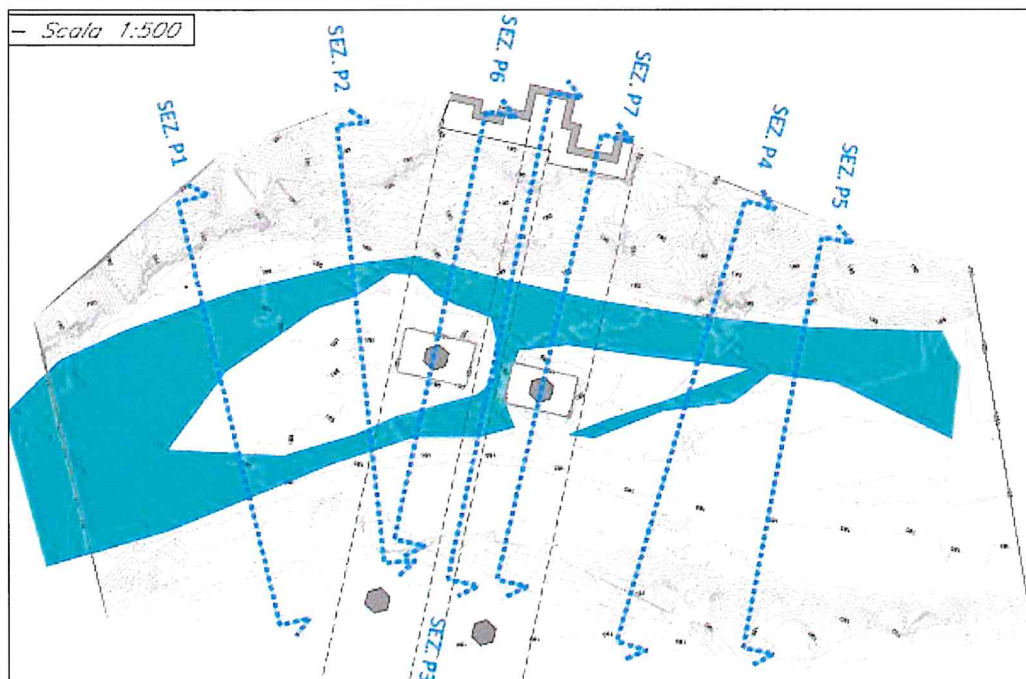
Planimetria stato di fatto (da Elab. B_02_Stato di fatto allegato allo SPA)
